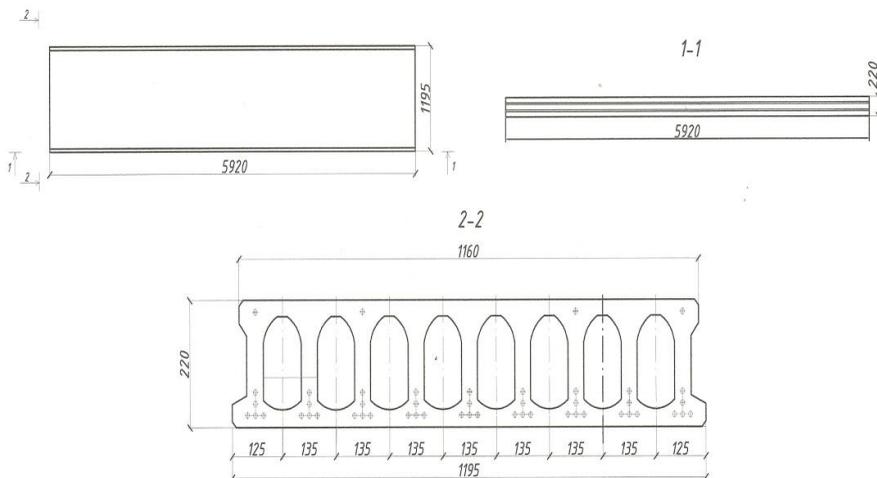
Плита перекрытия многопустотная ПБ-60.12
